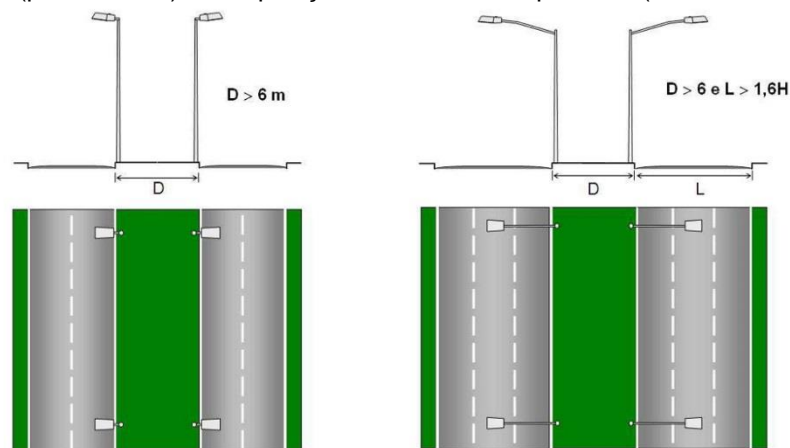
Croqui (planta baixa) da disposição das luminárias públicas (canteiro central)
